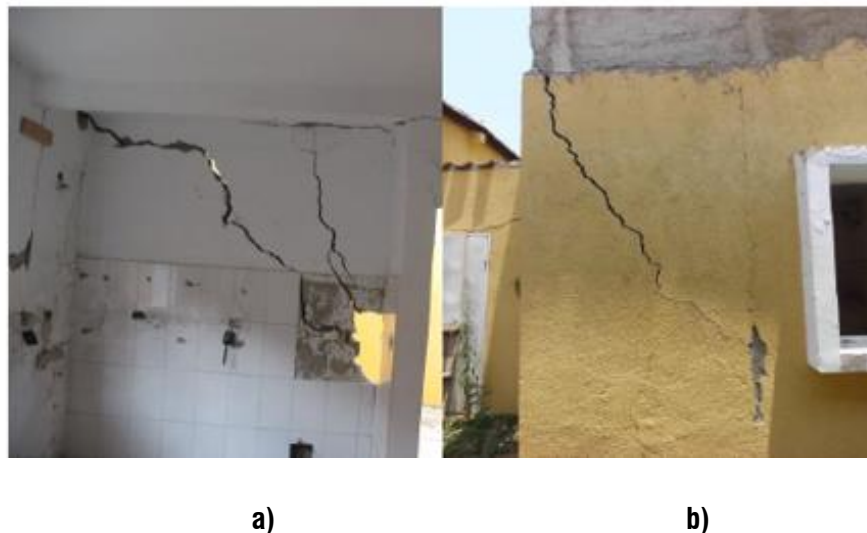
Vivienda dañada; (a) agrietamiento en muros (b) agrietamiento en fachada (Yépez et al., 2016).
